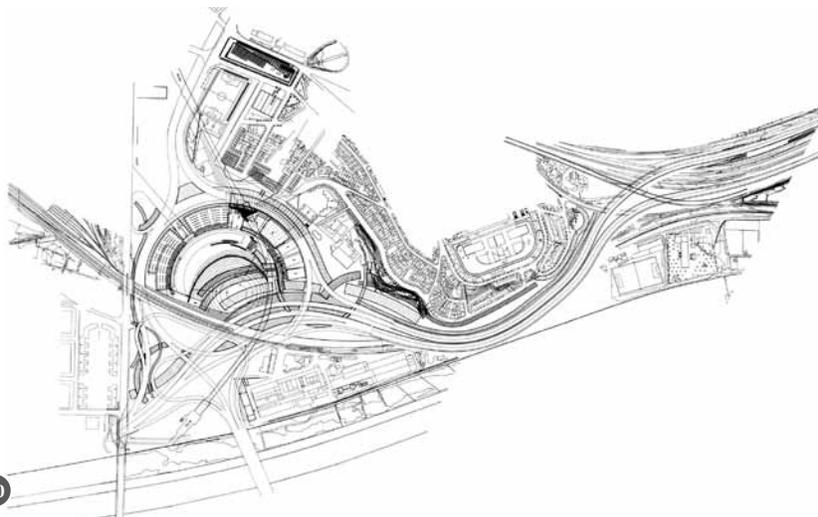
y 21. Planta conjunto, plano y fotografía del Parque Trinitat de Batlle y Roig.
